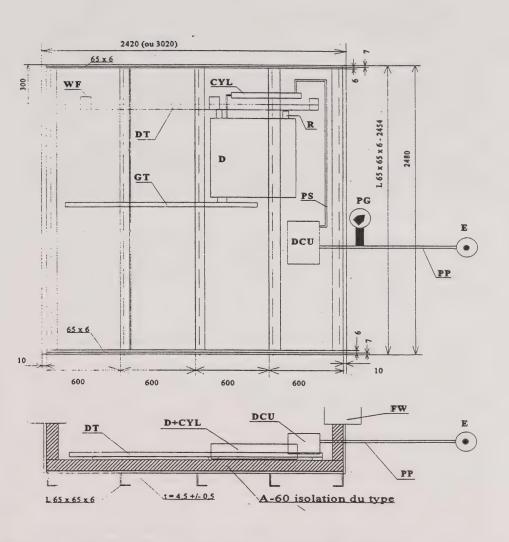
Ame destinée à recevoir le prototype de dispositif de commande des portes d'incendie.
